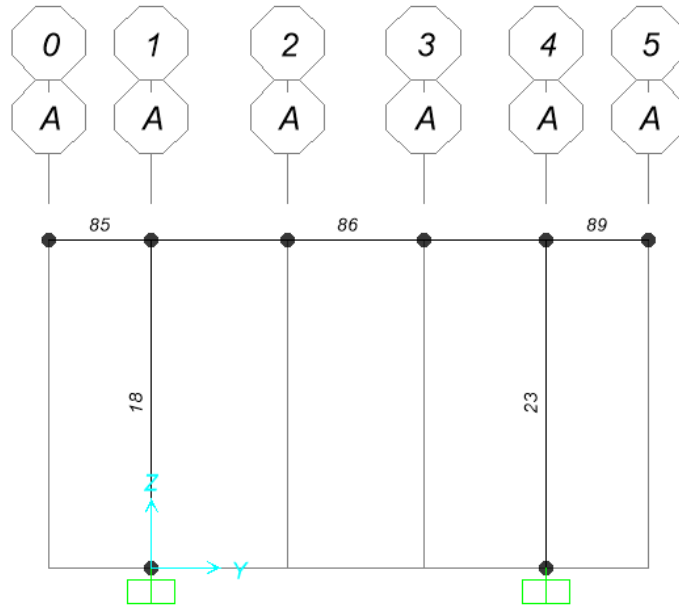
Vista in sezione modello struttura in elevazione –Filo A - numerazione elementi frame e joint
